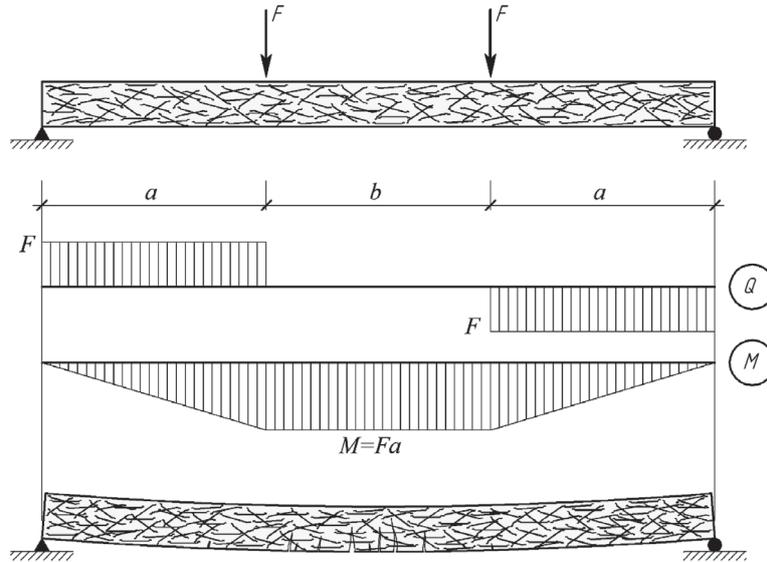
Схема образования нормальных к продольной оси трещин в зоне чистого изгиба однопролетной фибробетонной балки
